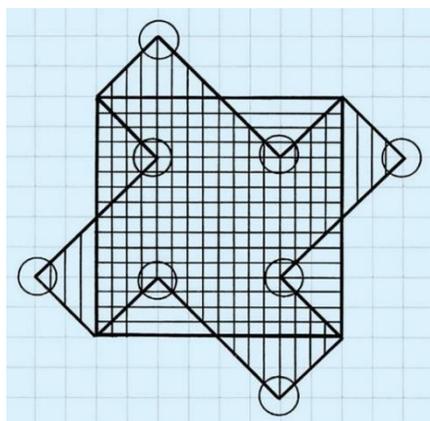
Схемы двух разных по форме планов этажей здания, имеющих одинаковую площадь
